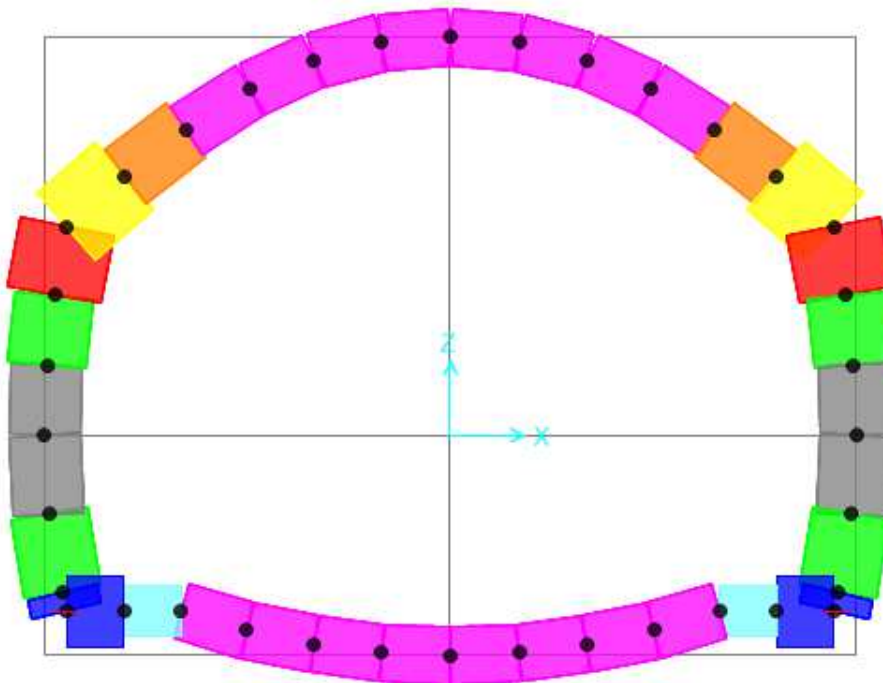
Sezione GA: modello sezione trasversale - Sezioni
